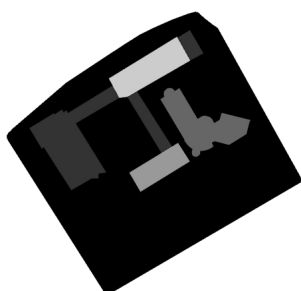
Esquema da planta de implantação da Escola Secundária D. Sancho II, em Évora.
